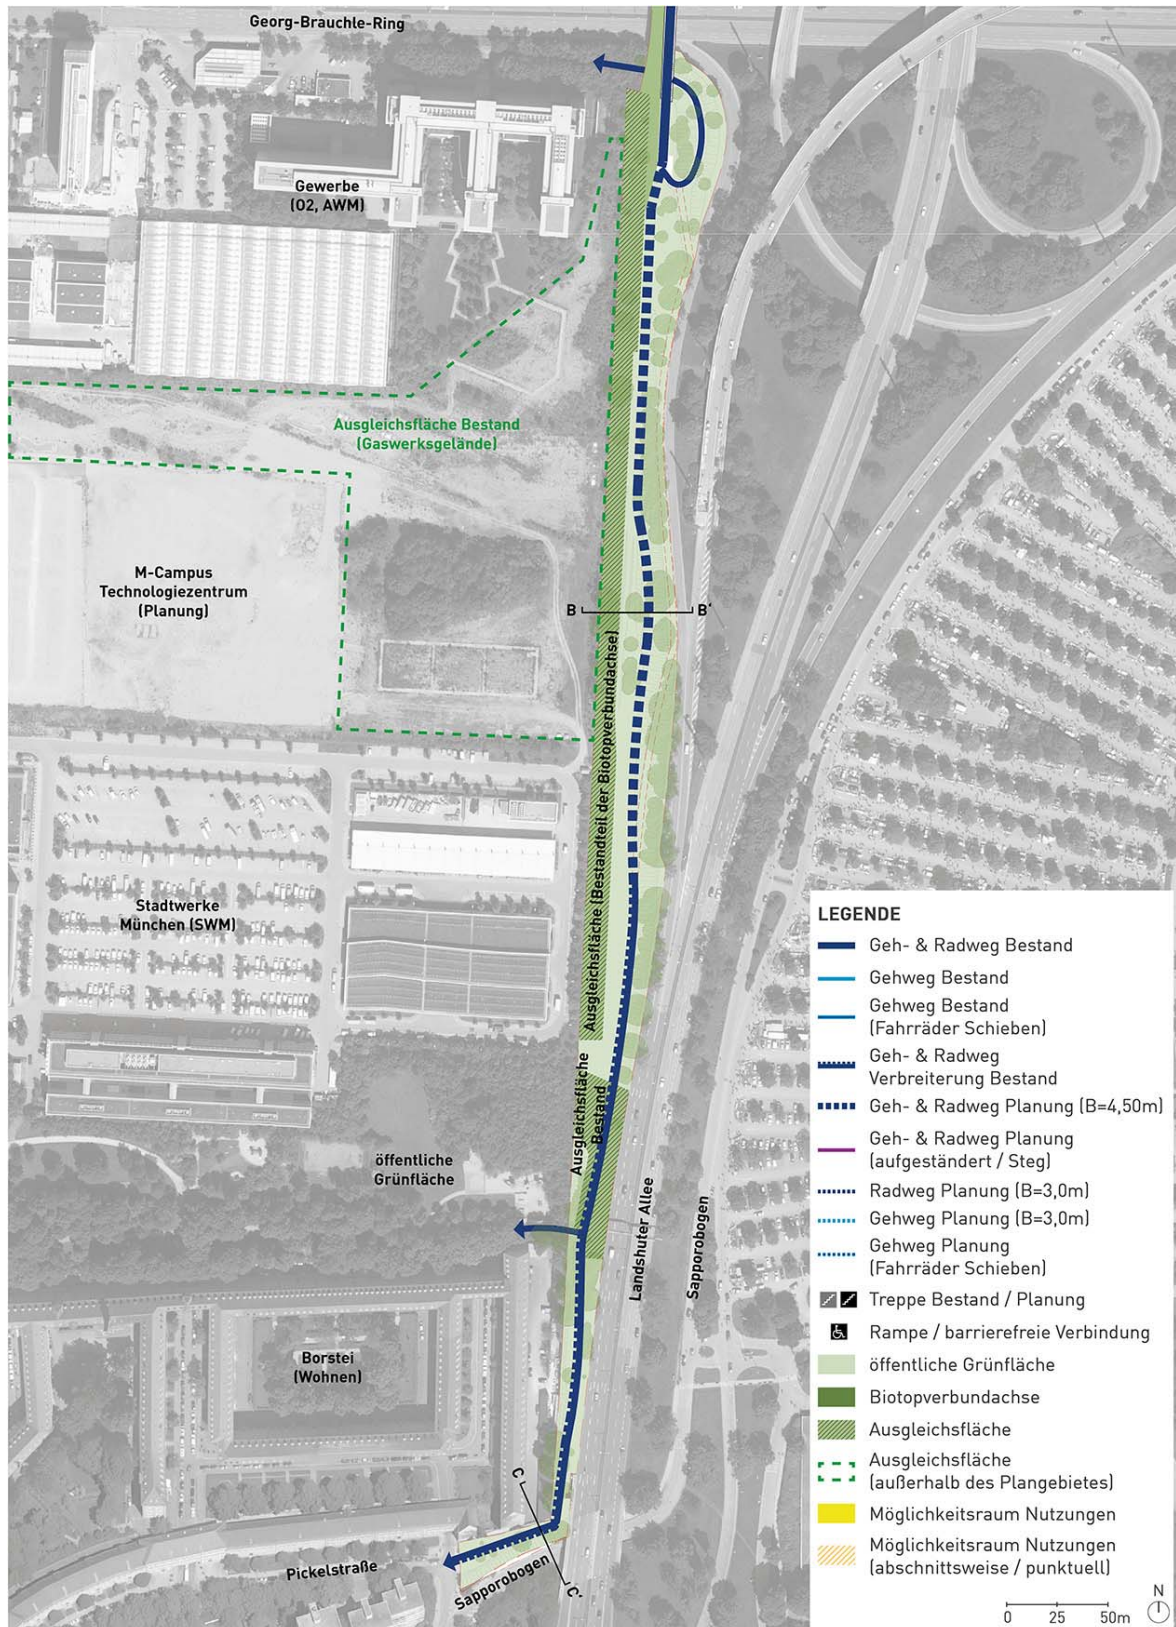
Teilbereich Süd (Verkleinerung, Originalmaßstab Lageplan 1:1000)
